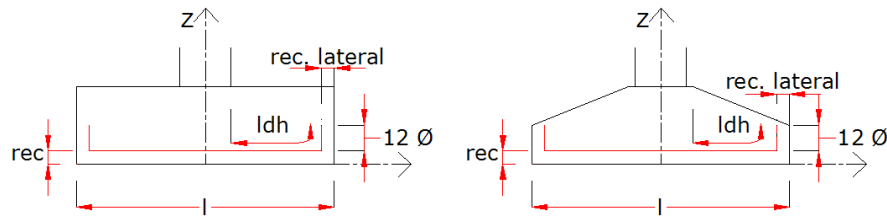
Longitud de anclaje de armaduras de flexión. Fuente: elaboración propia.
